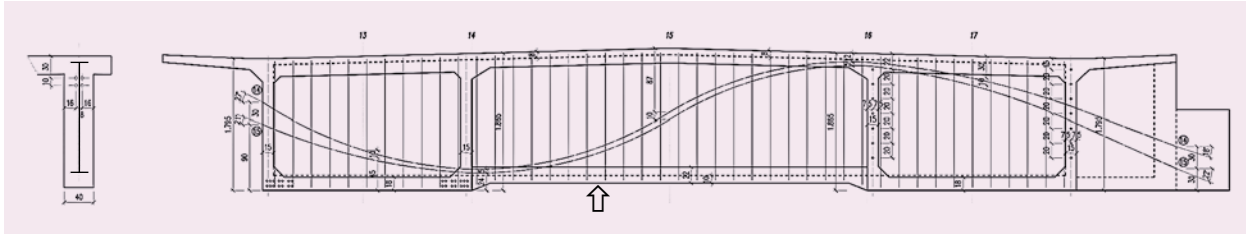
entretoise mixte béton précontraint/poutre acier avec localisation de la photo 13 – Source : bureau Rw Consult (Luxembourg)
